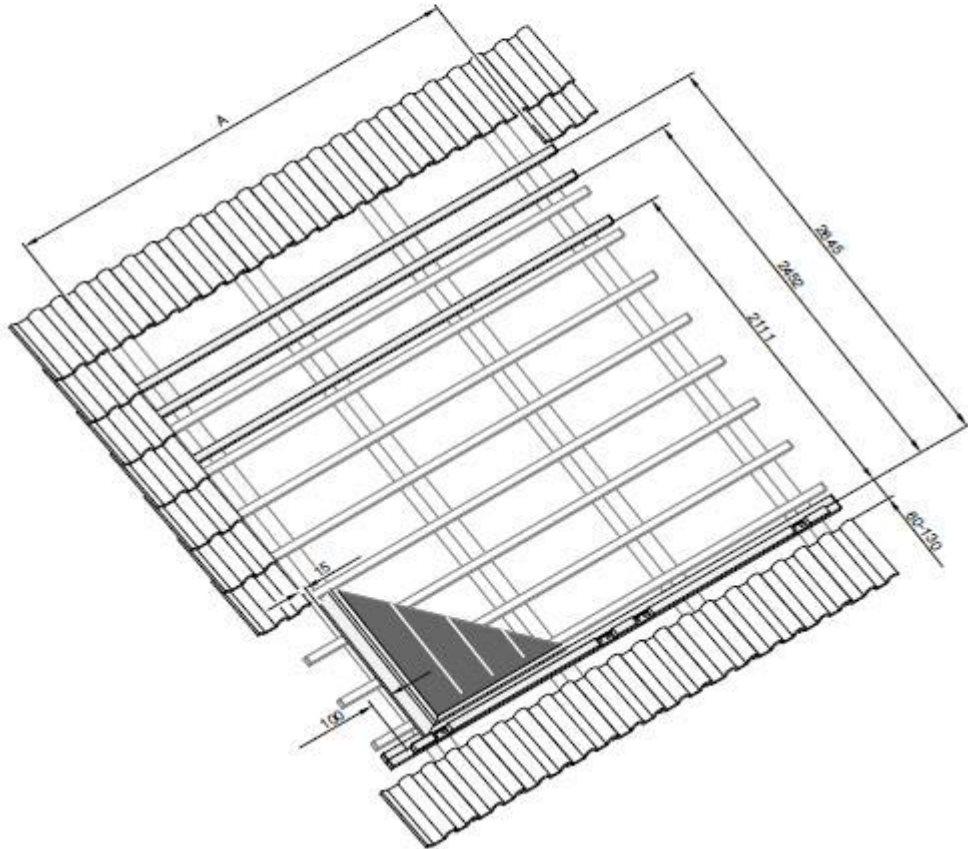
Dimensions pour l'intégration de capteurs C20-Tuiles à emboîtement ou à glissement à relief.
